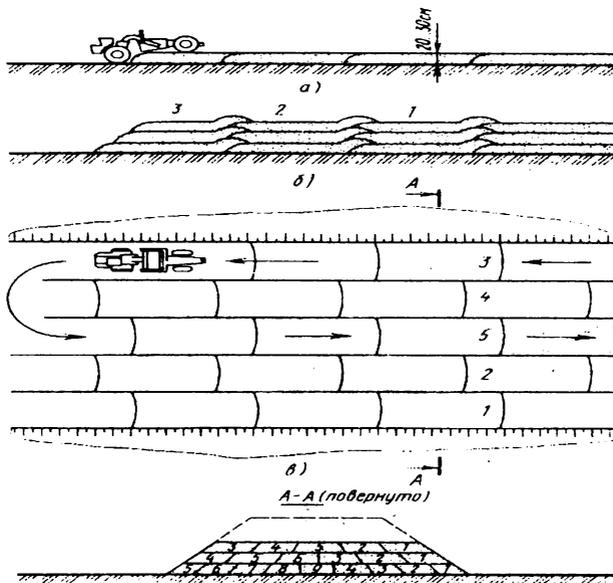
Схемы отсыпки грунта при разгрузке:
